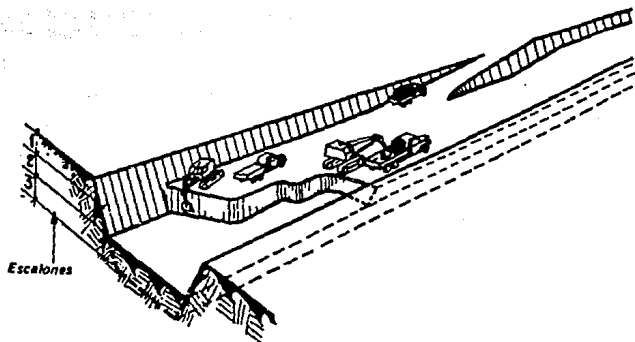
Máquinas realizando excavación en capas a plena anchura.
